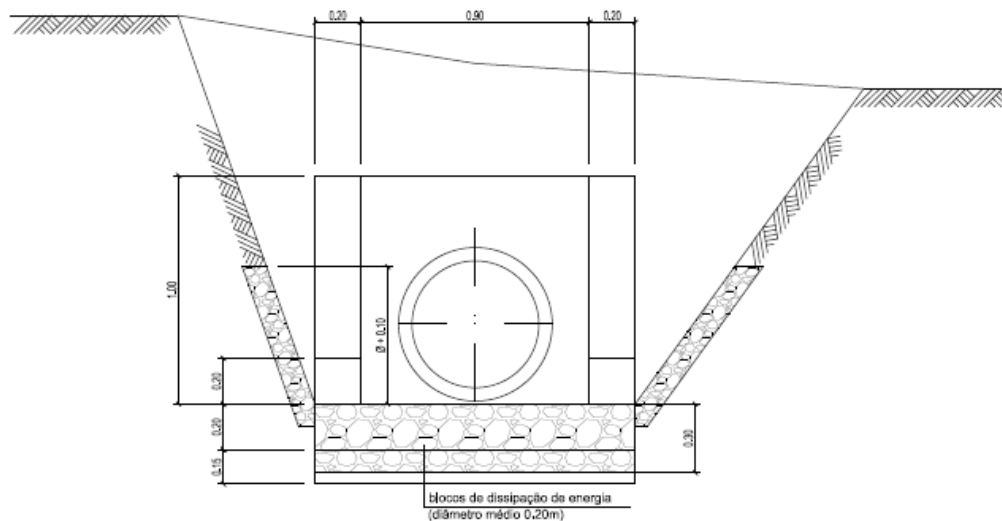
Corte longitudinal tipo da descarga em boca de lobo
